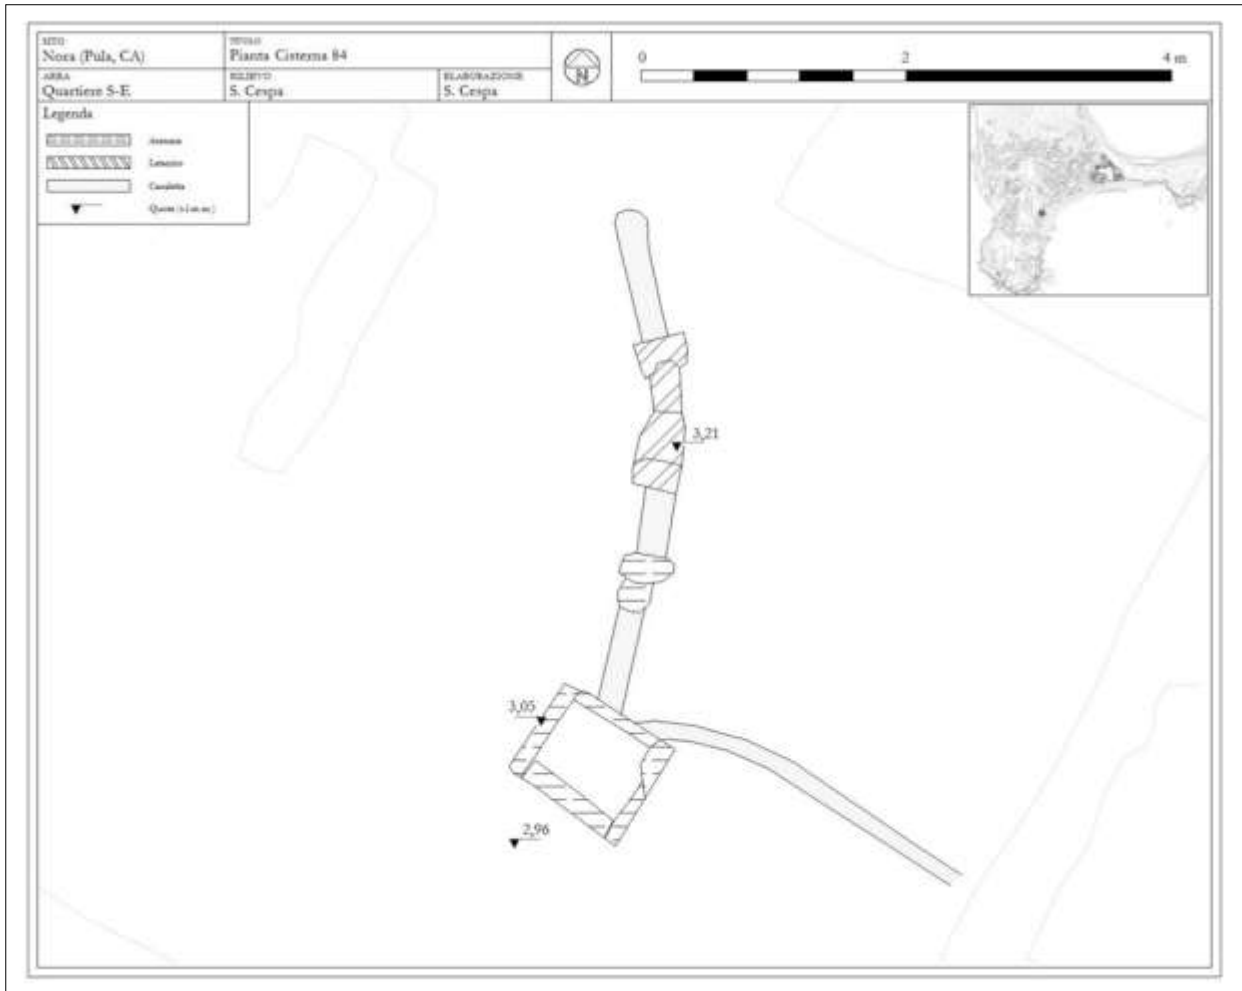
Pianta della cisterna 84 (elaborazione dell'autore).
